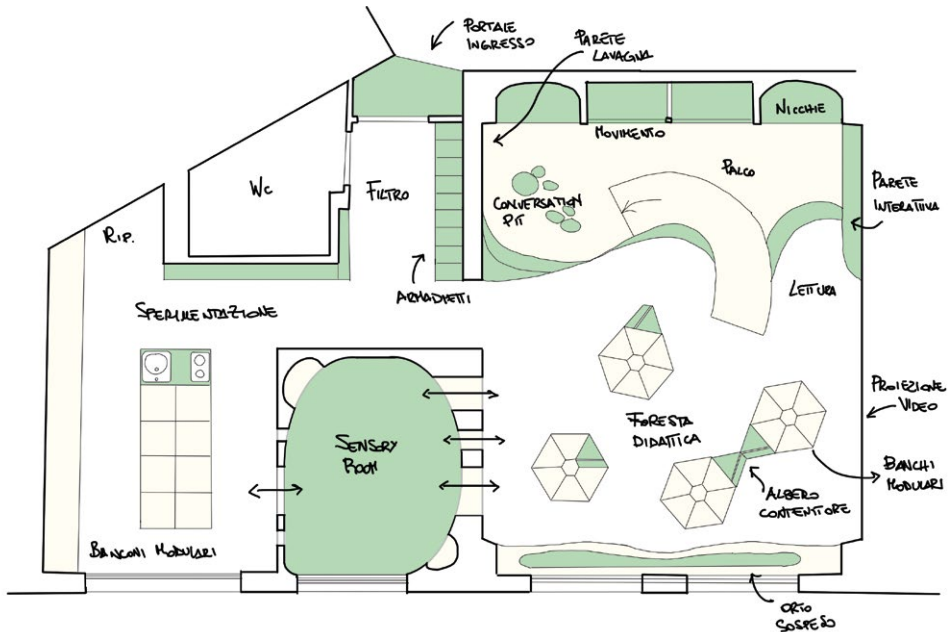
Schema planimetrico degli spazi laboratorio SpInLAB.
